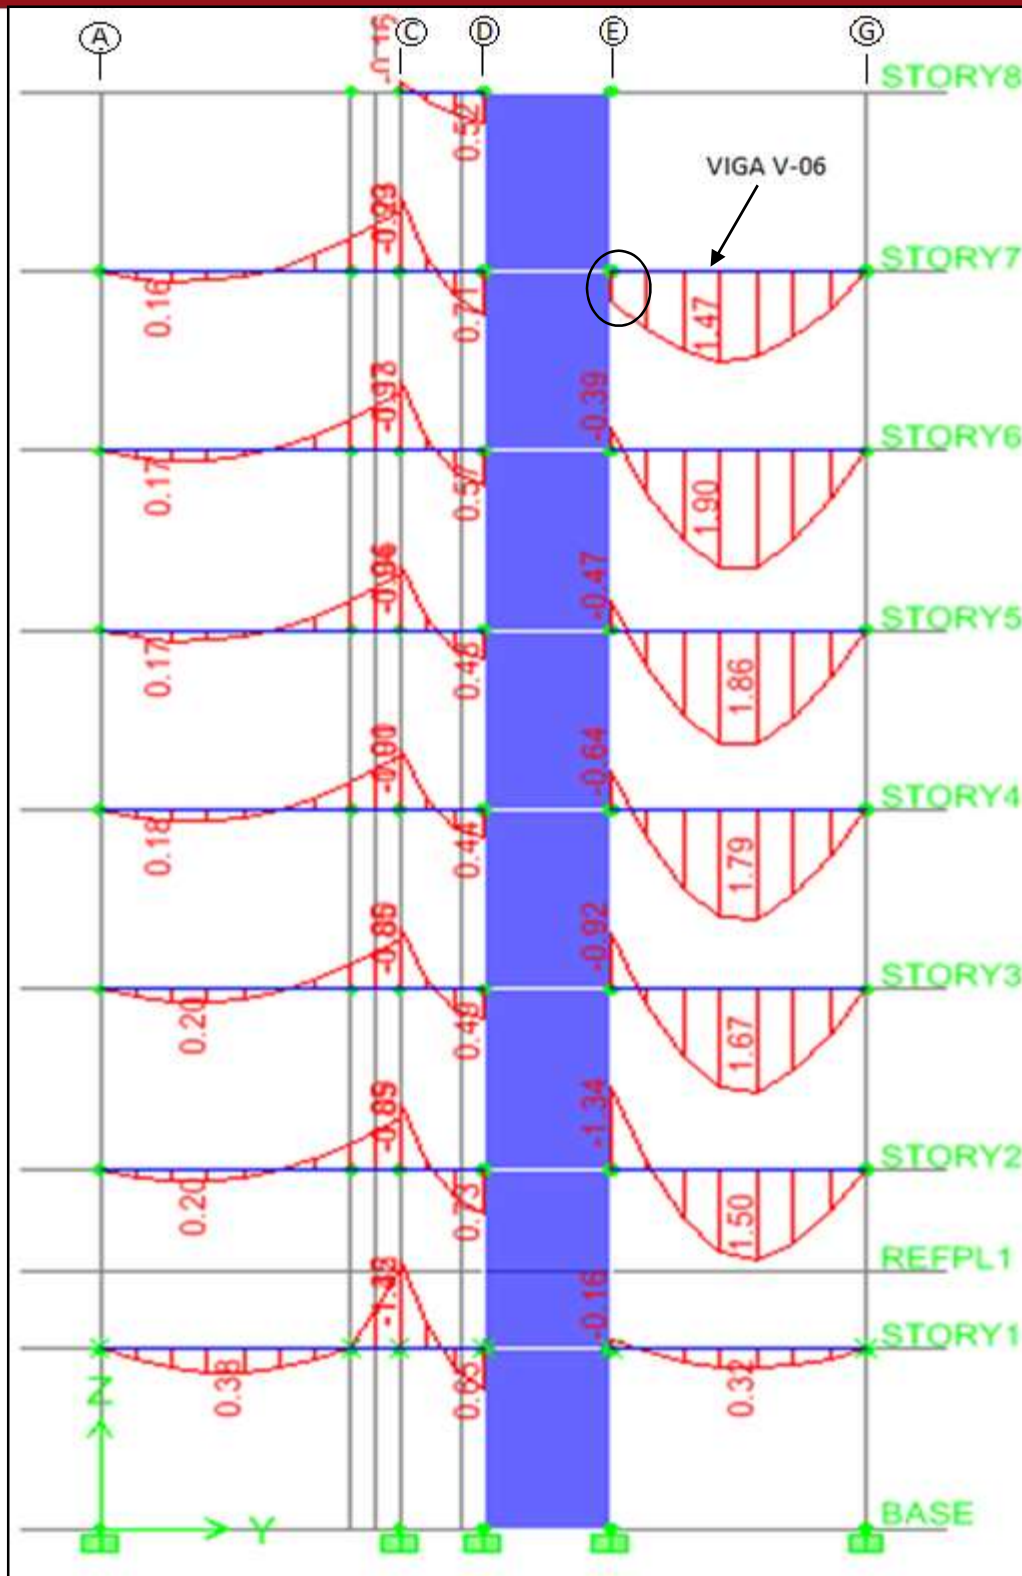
Diagrama de momento flector en vigas del pórtico del eje 10 sin considerar el proceso constructivo (ton-m).
